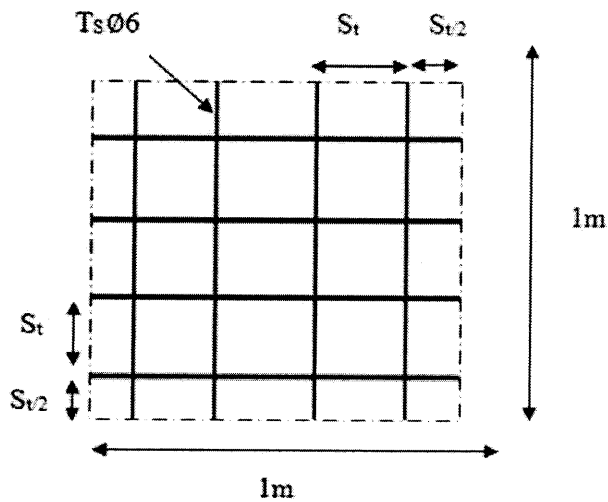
disposition constructive des armatures de la dalle de compression.
